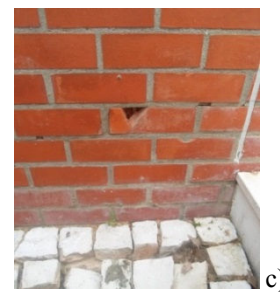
Exemplos de esmagamento do tijolo face-à-vista
